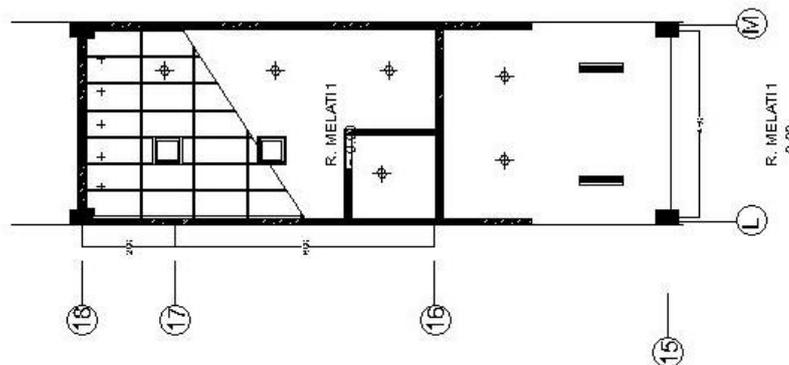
Rencana lantai *layout* ruang Melati
